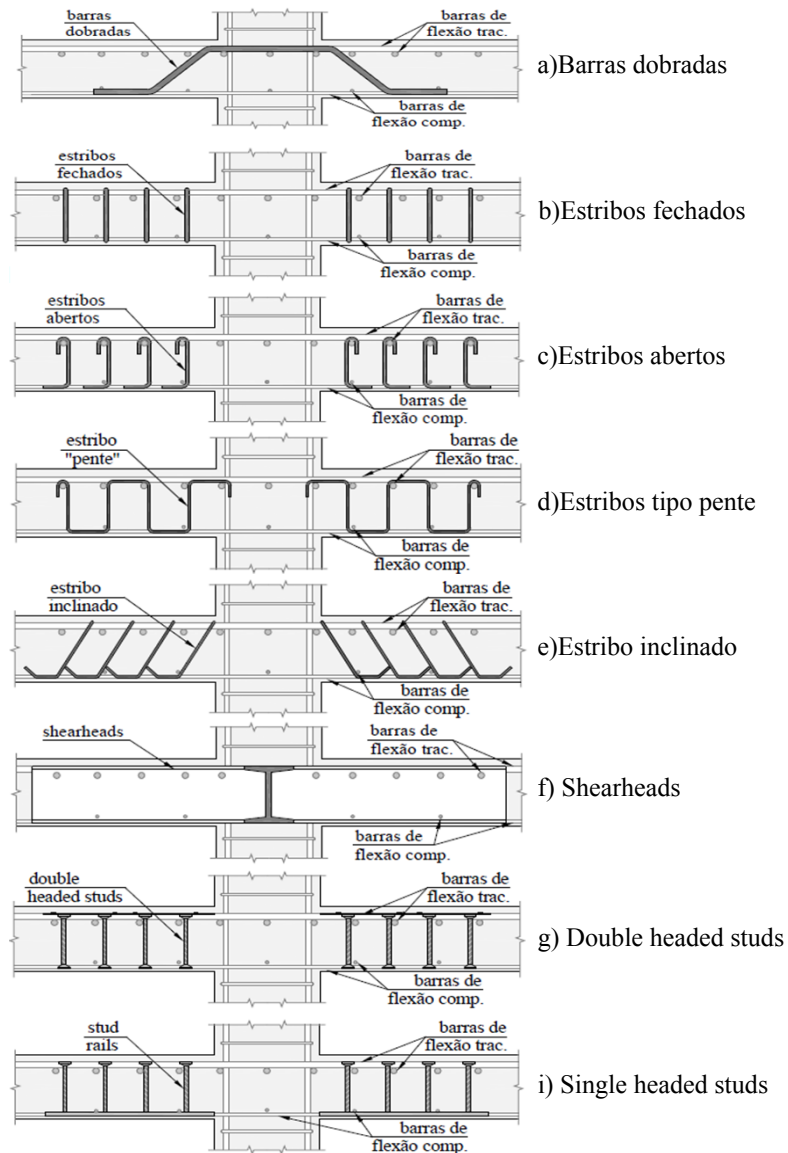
Tipos de armaduras de cisalhamento, Ferreira (2010)
